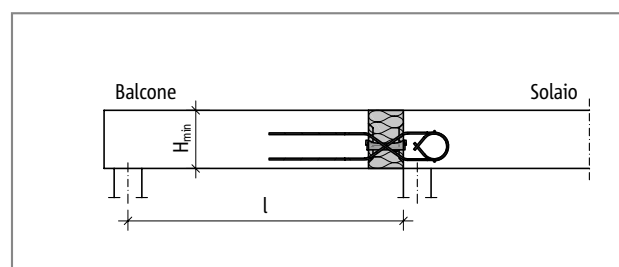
Schöck Isokorb® tipo QXT+QXT: sistema statico (tipo da QXT10+QXT10 a QXT40+QXT40)
